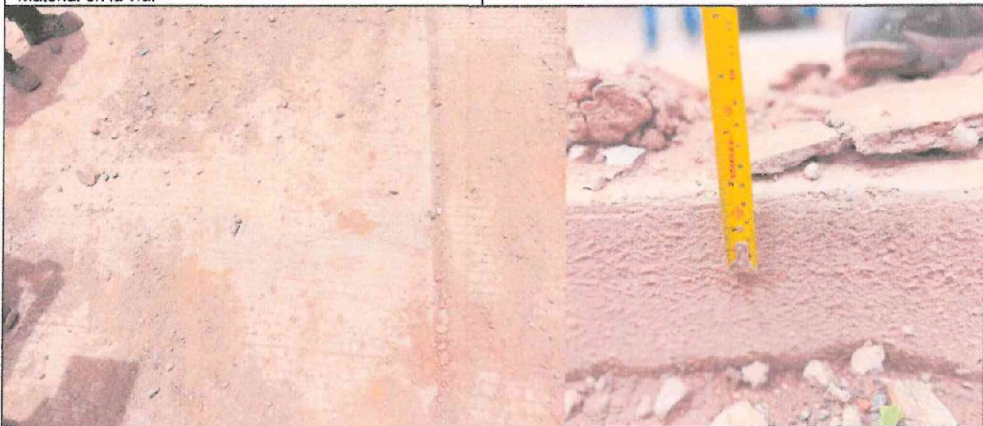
Se las fisuras en pavimento ubicado en la calle sin nombre 84.
